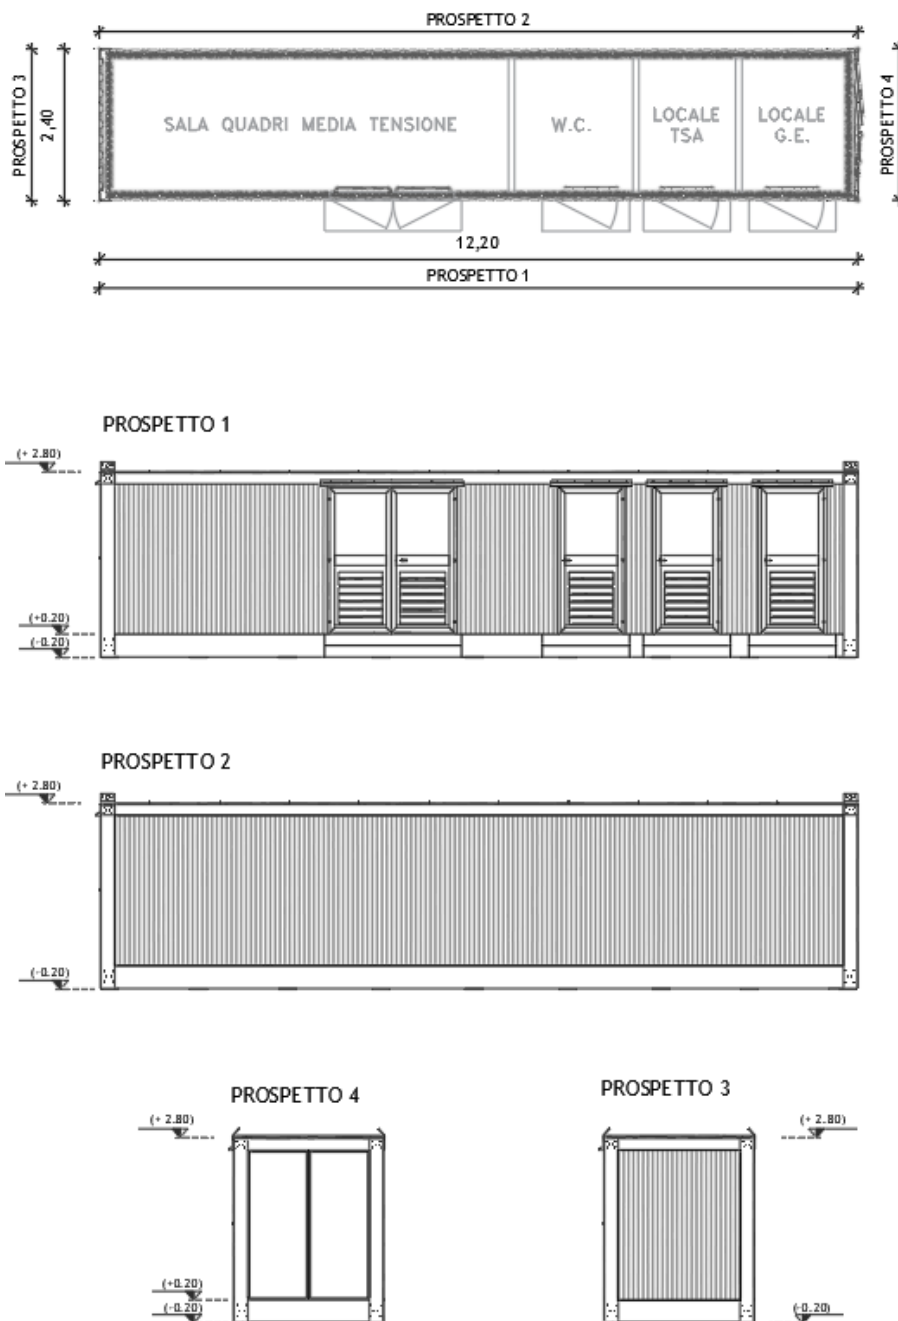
Pianta e prospetti dell'Edificio Quadri
